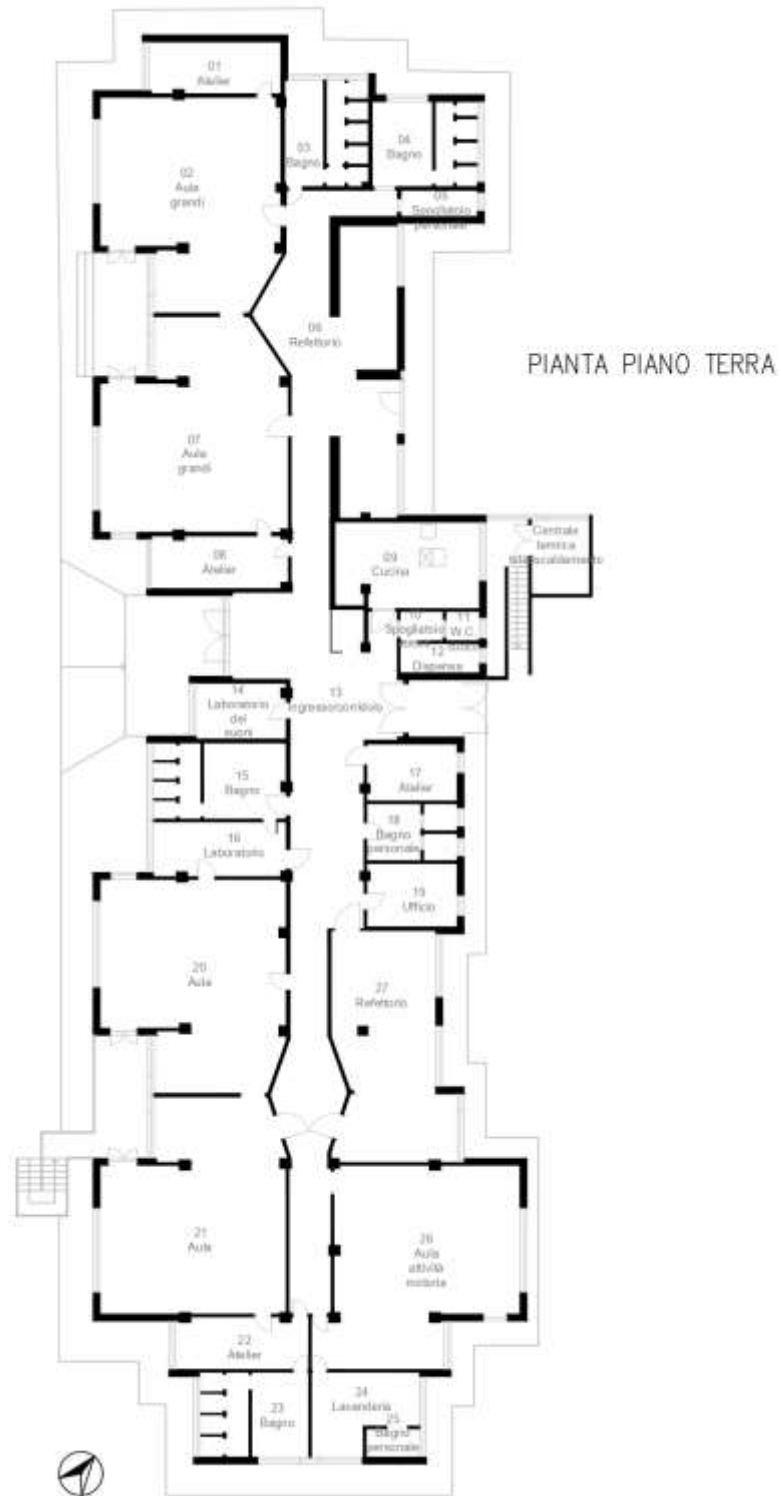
PIANTA PIANO TERRA - IDENTIFICAZIONE NUMERICA DEI LOCALI
